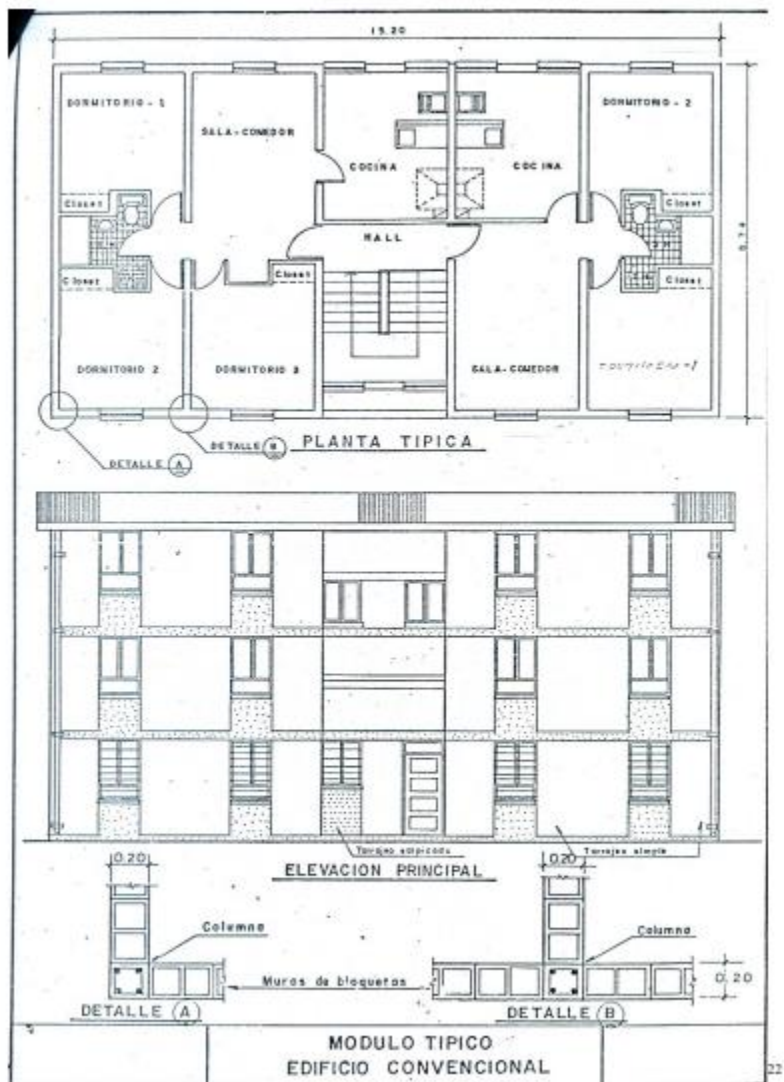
Edificio típico de albañilería, planta y elevación principal
